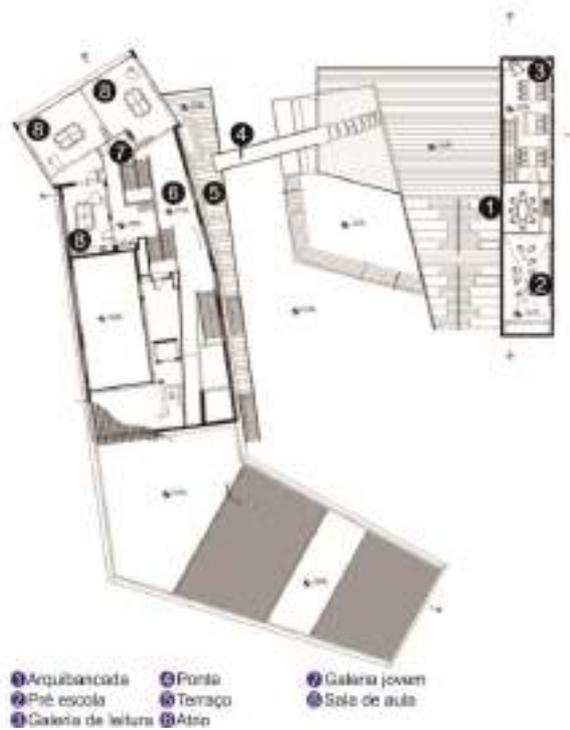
Centro Comunitário Rehovot (a) planta layout térreo
